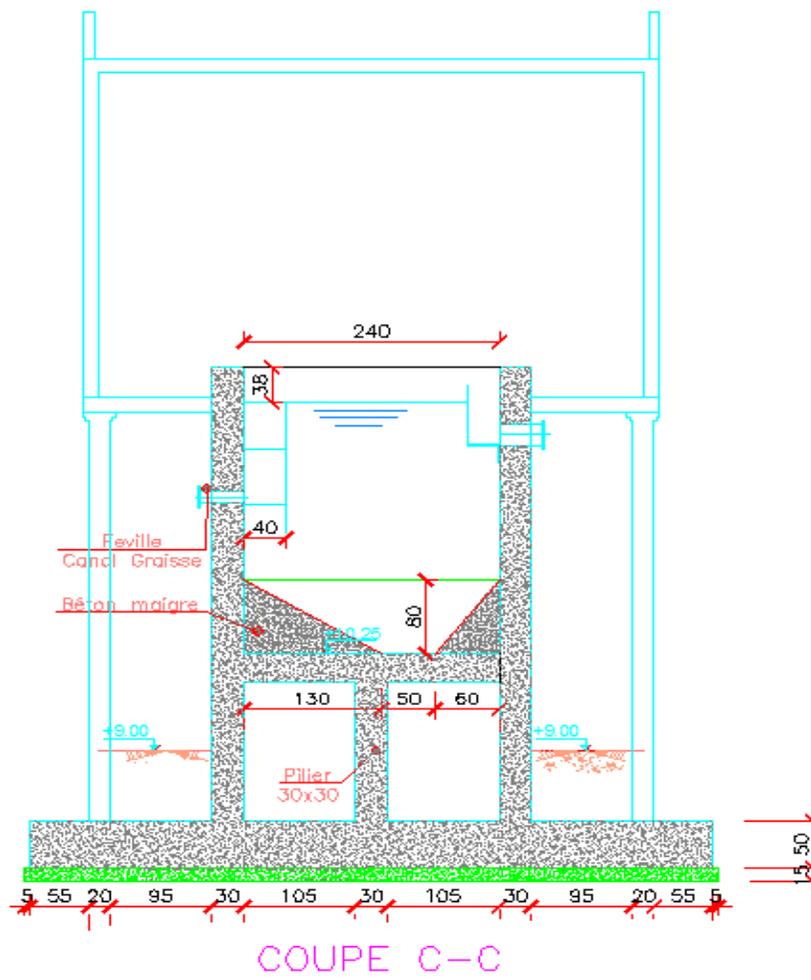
Plan de la partie station de traitement de la STEP COUPE CC
